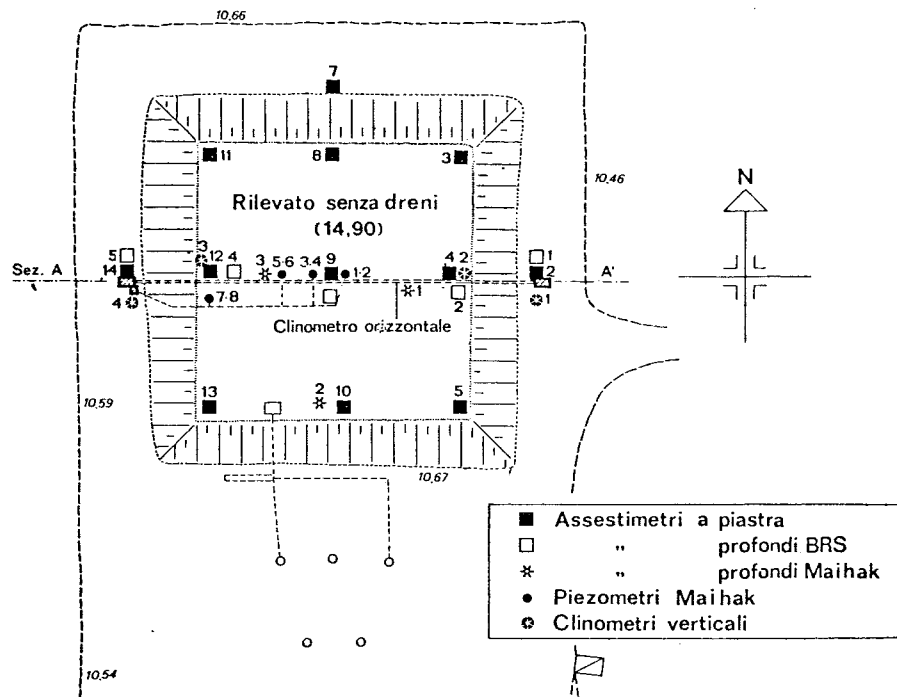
Rilevato sperimentale di Sermide - planimetria.
